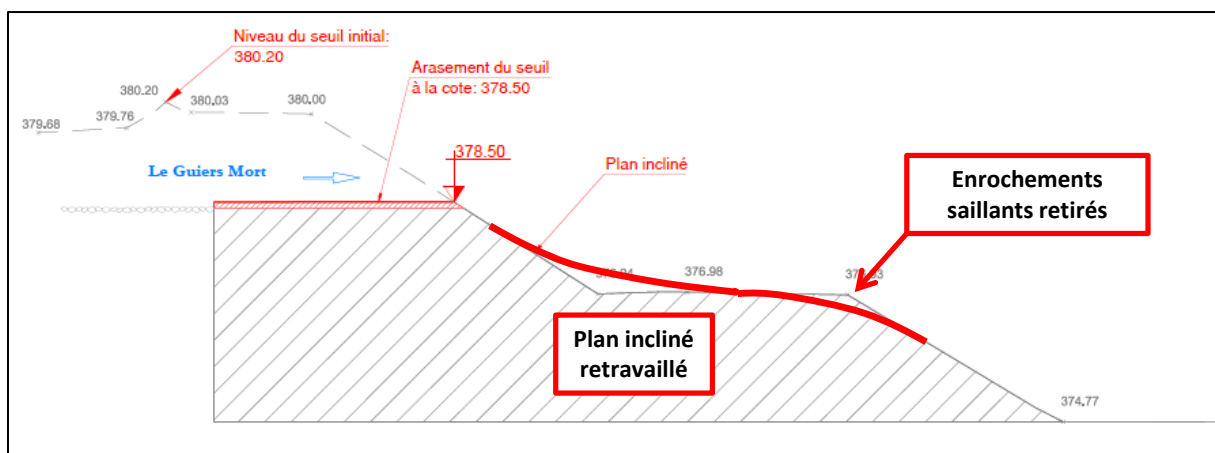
Plan de principe pour l'adoucissement du parement incliné
